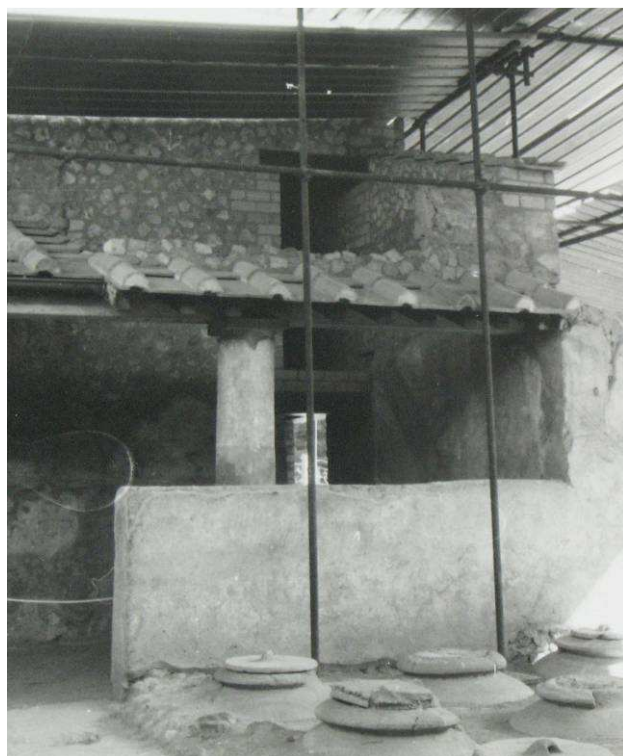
La zona del portico nord con il muro di facciata del fienile dopo l'intervento di ricostruzione (arch. foto SANP - D-103548 del 3-3-2000).
